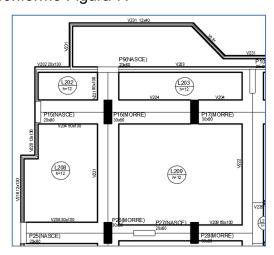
Trecho da forma estrutural – Pilares em transição. Fonte: Autores
